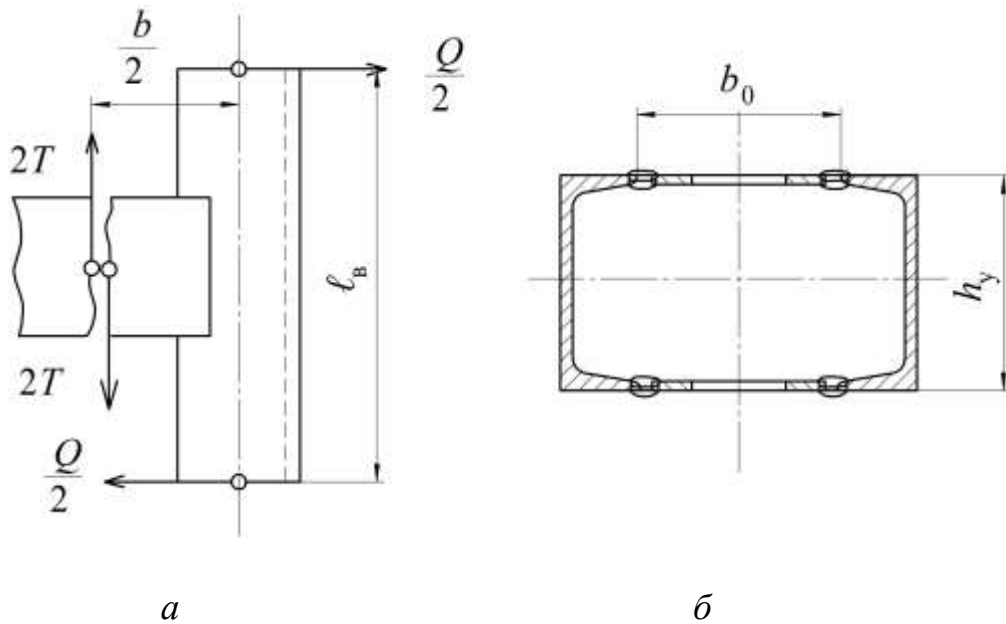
Расчетные схемы при соединении планок к ветвям:
